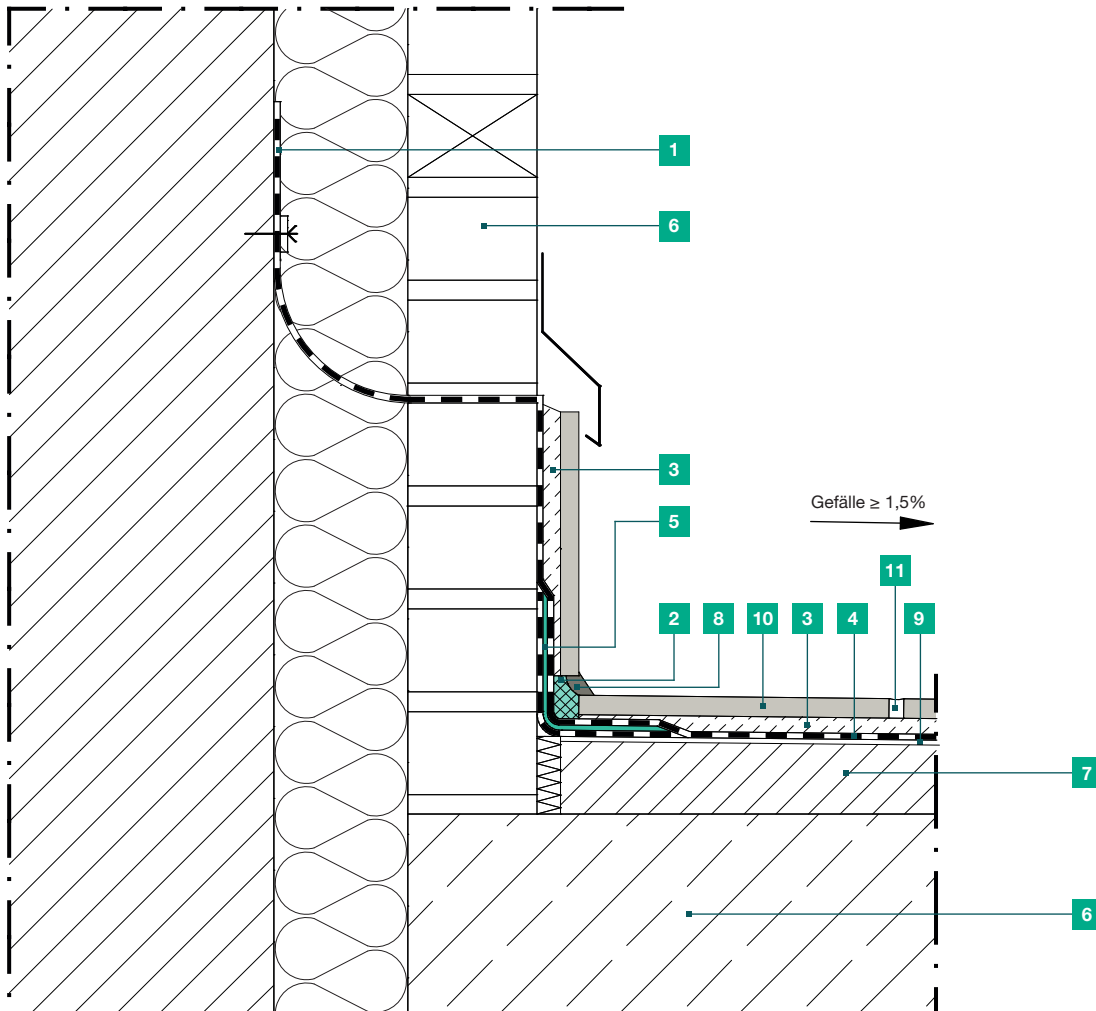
Wand-Boden-Anschluss (Mauerwerk 2-schalig) - Abdichtung mit DIGHT FDS 2K
